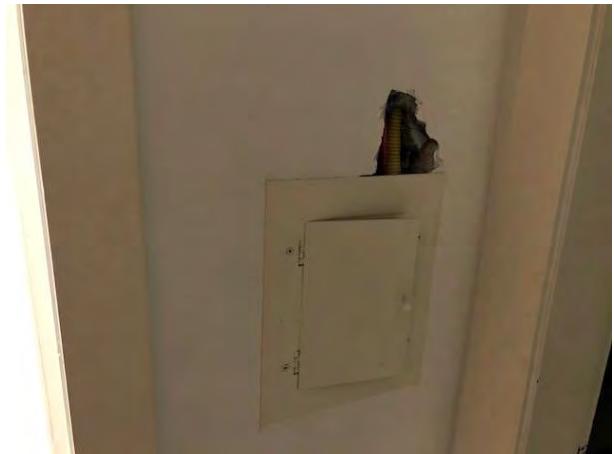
APTO Nº 1106 – REPARO A SER REALIZADO
